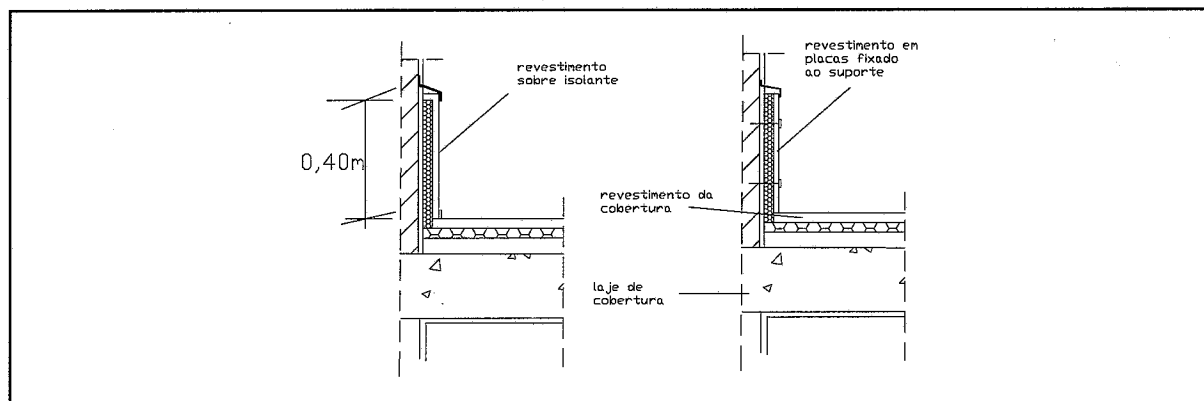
Pormenor da reabilitação térmica da ligação entre laje de cobertura e parede divisória
